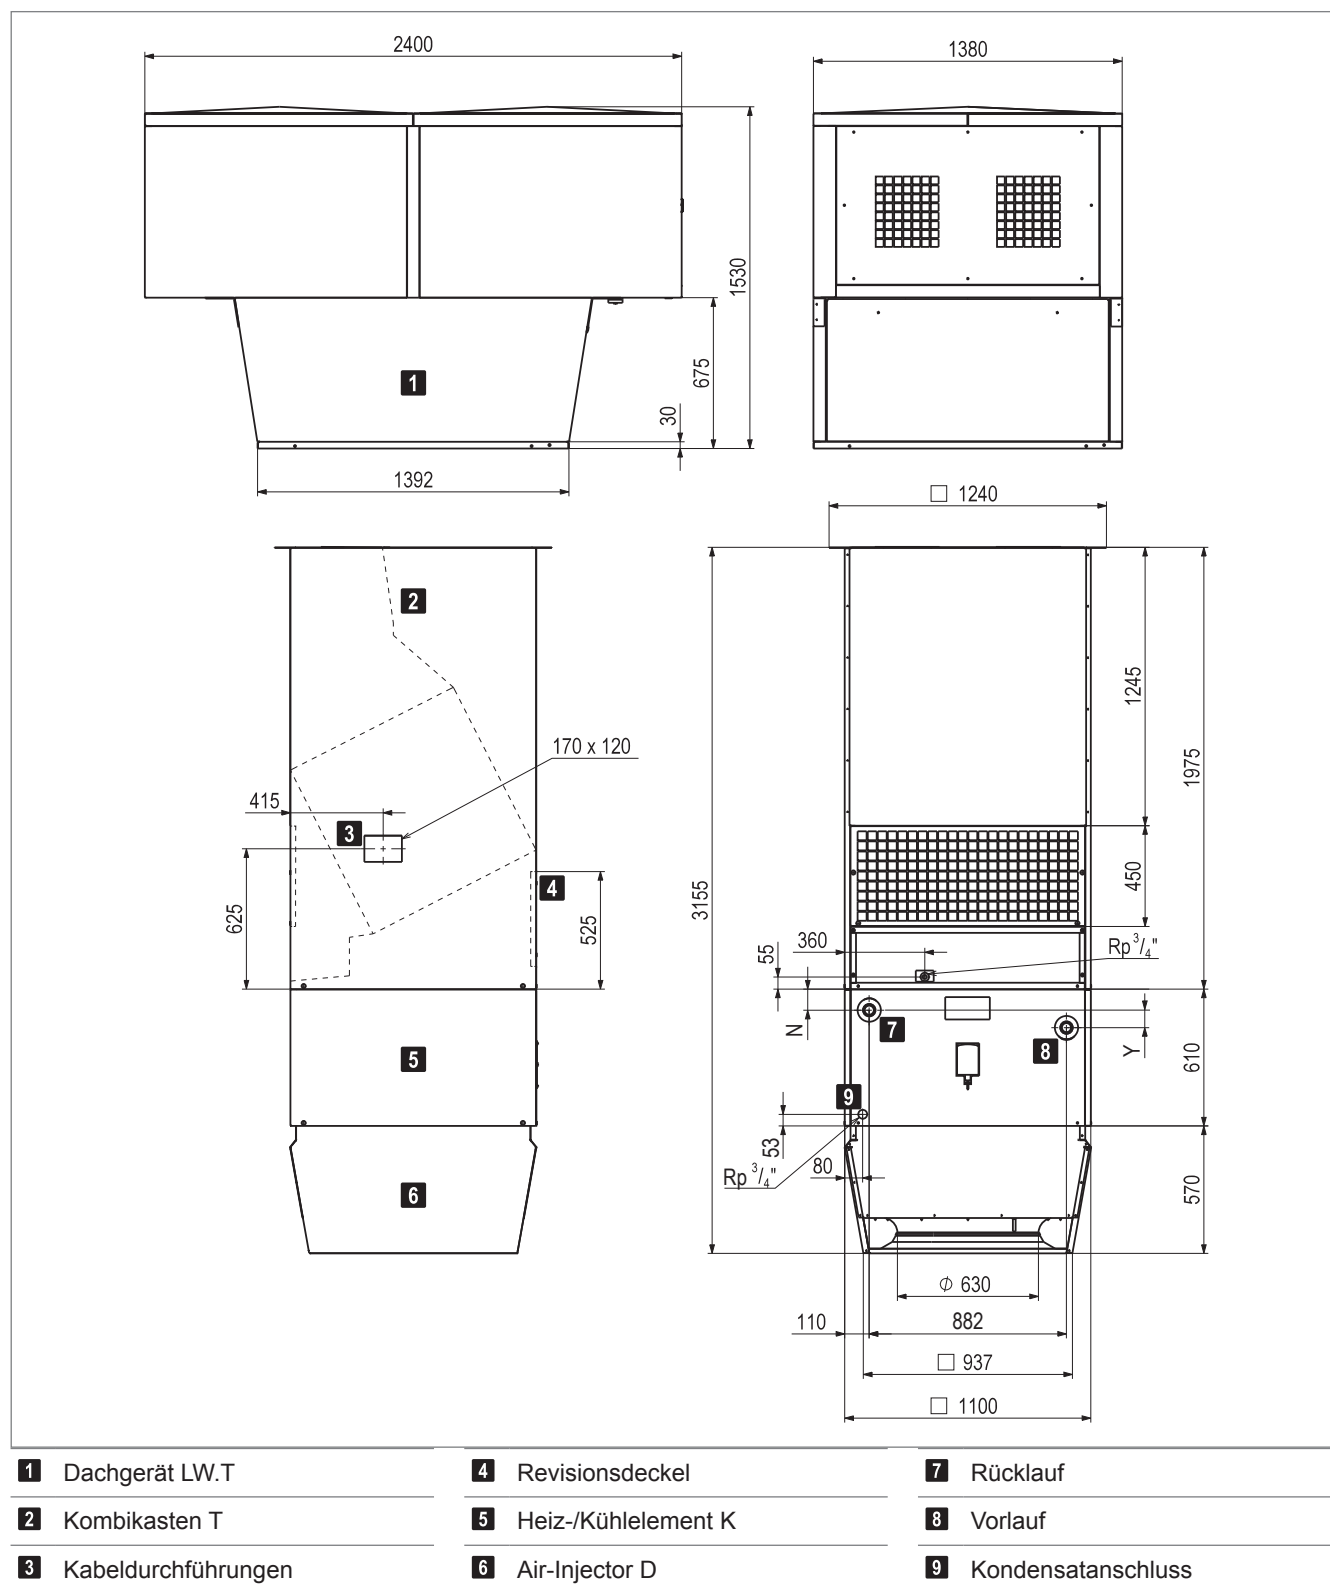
Maßblatt für RoofVent® twin cool (Maße in mm)
